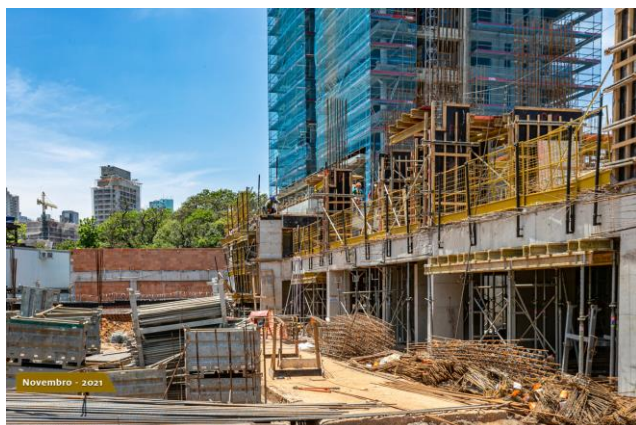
Montagem de moldes para concretagem de estrutura em concreto armado
